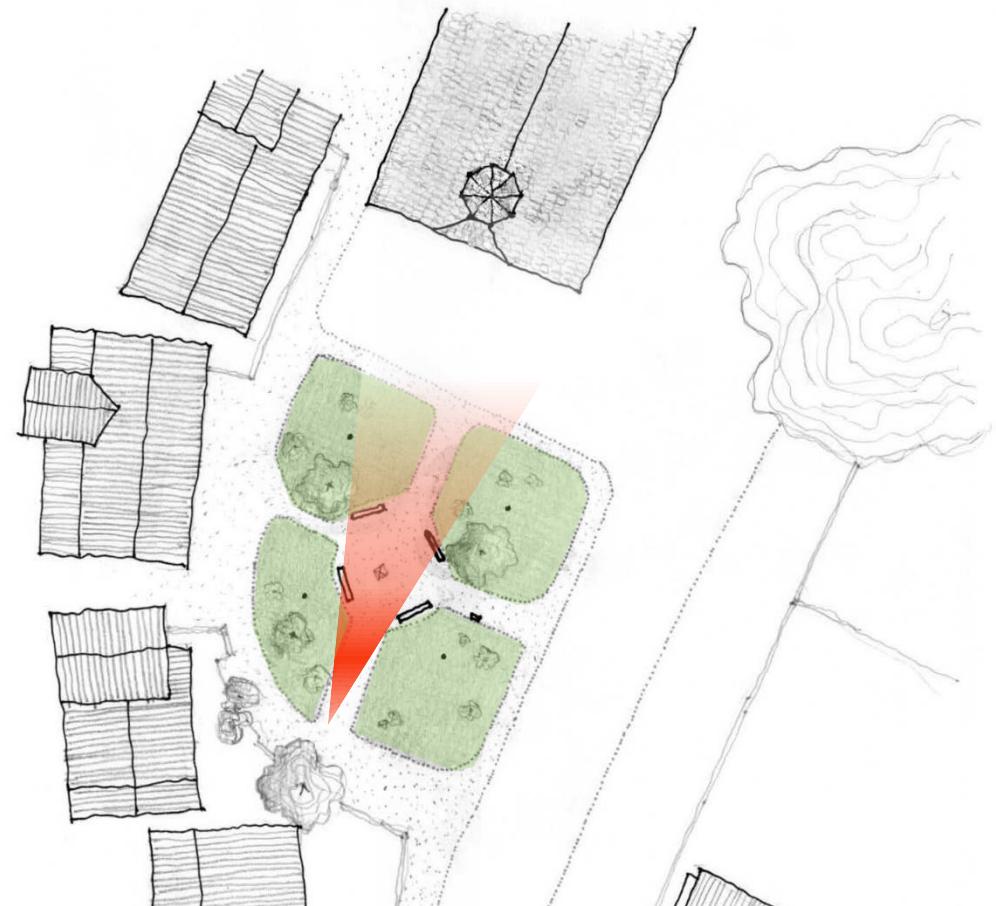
Ilustración trazado plaza. Fuente: OTP Chiloé, 2025.
